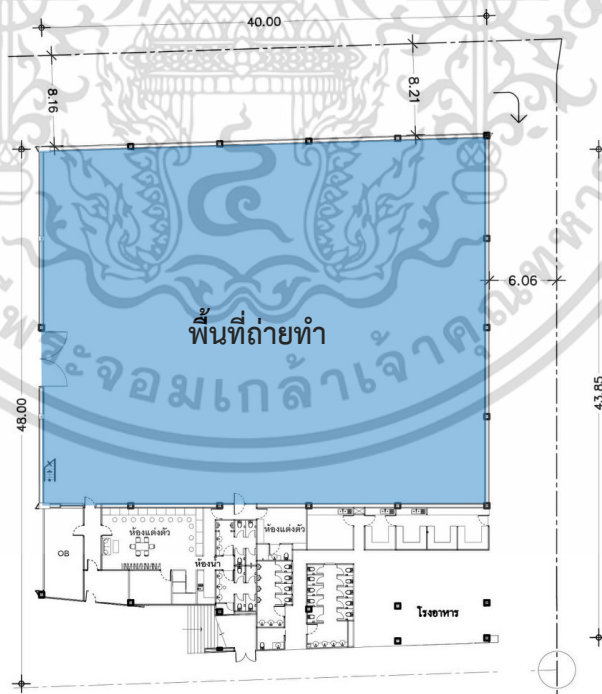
ภาพแสดงผังสตูดิโอ 1 โครงการ TVT Green Park Studio
